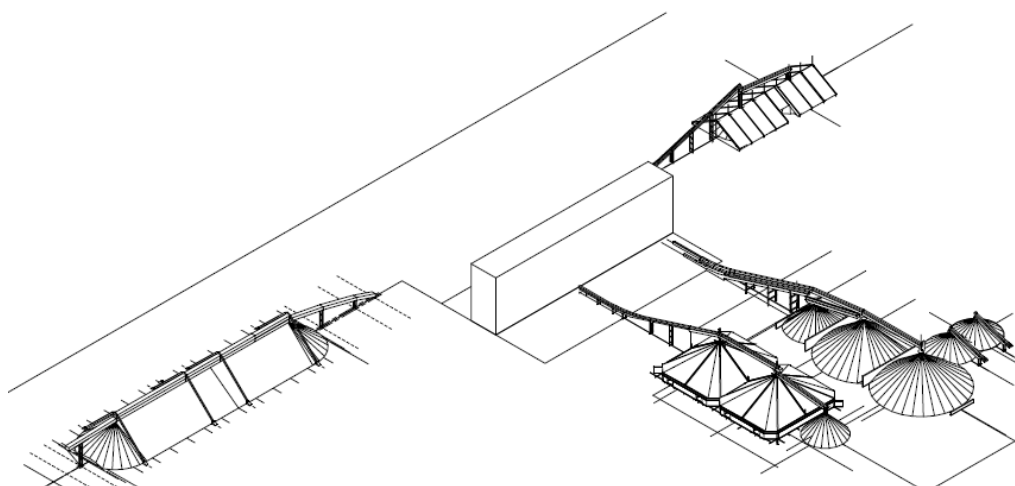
a Pianta 3d area calcare situazione esistente
